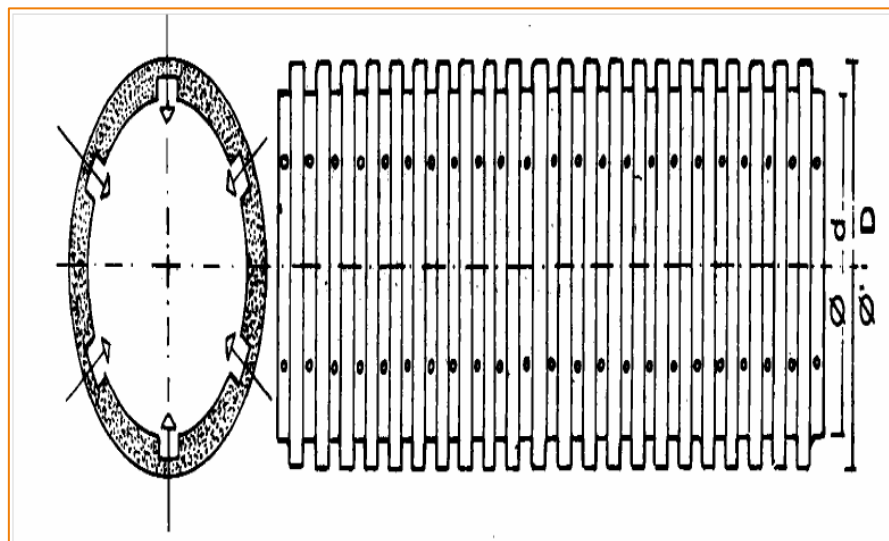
Tubo para drenaje de PVC, ondulado y sección circular.
